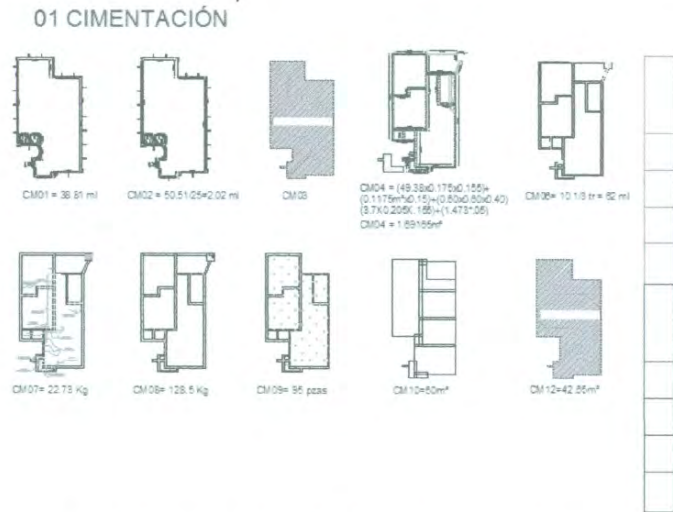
Plano de cimentación para cubicar las cantidades de insumos
